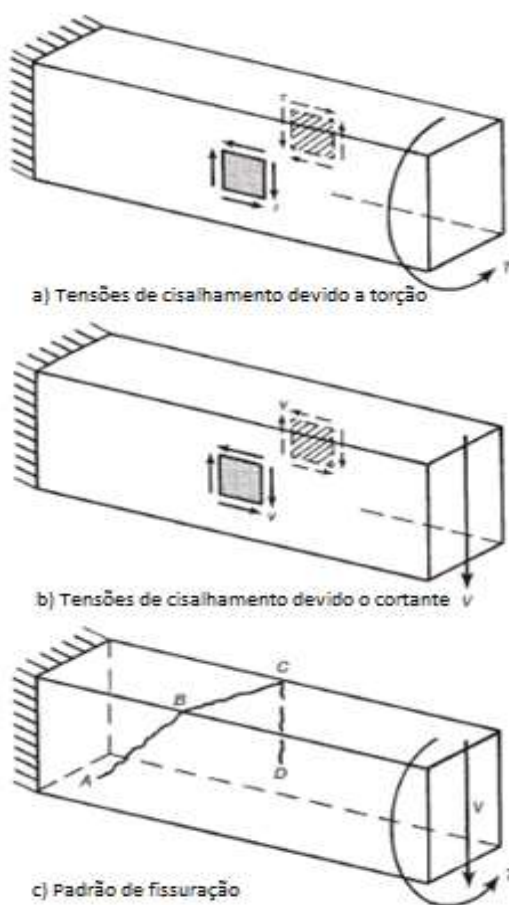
Tensões principais e fissuração devido torção pura
